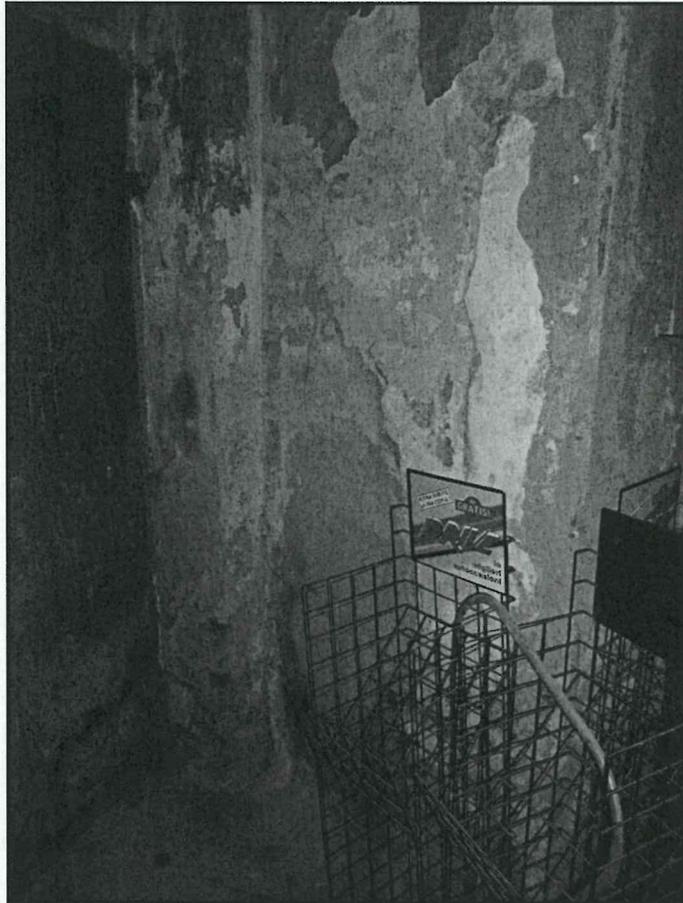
Vano scala che conduce a soffitte (Civ.17) – Murature verticali a Piano Terra
